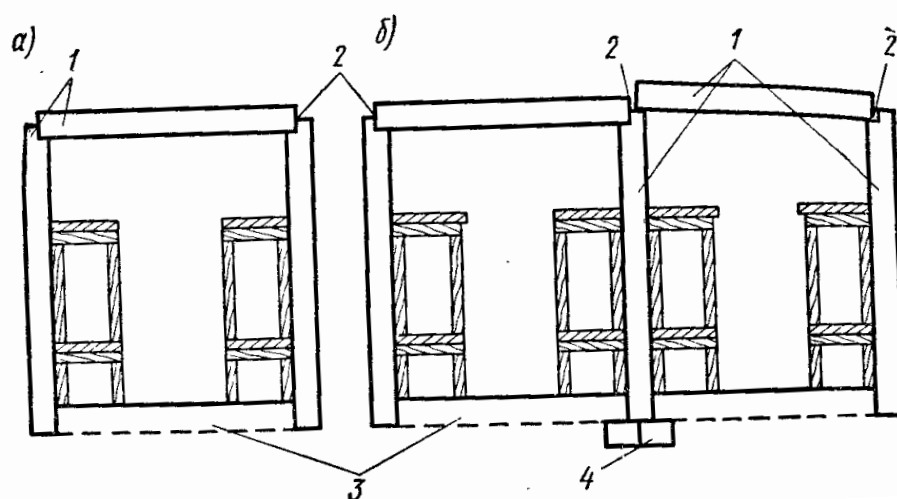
Конструктивные решения убежищ из железобетонных элементов, изготовленных в существующей оснастке, где
